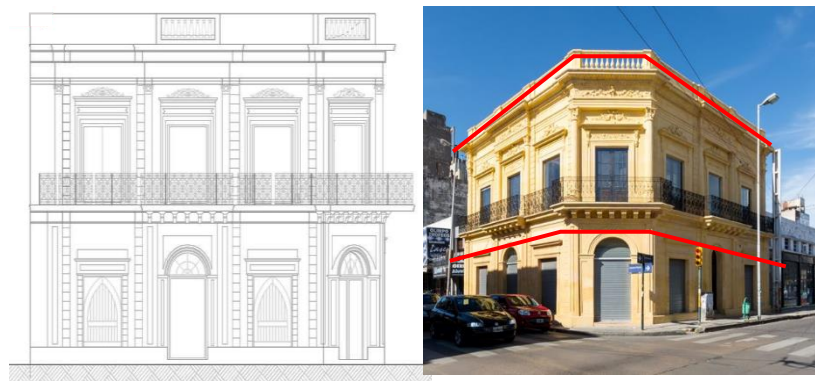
Fachada, conservada y restaurada Fuente: Archdaily
